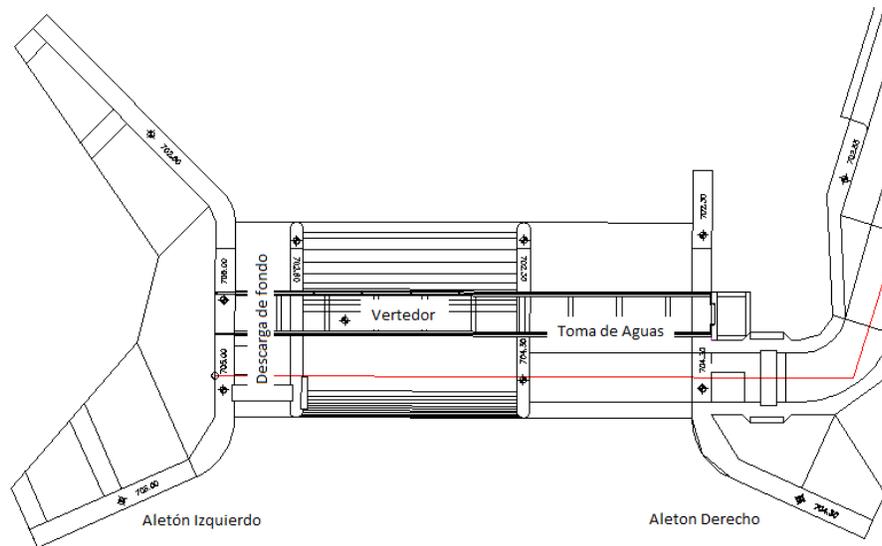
Elementos estructurales que componen el Sitio de Presa. Extraído de planos
